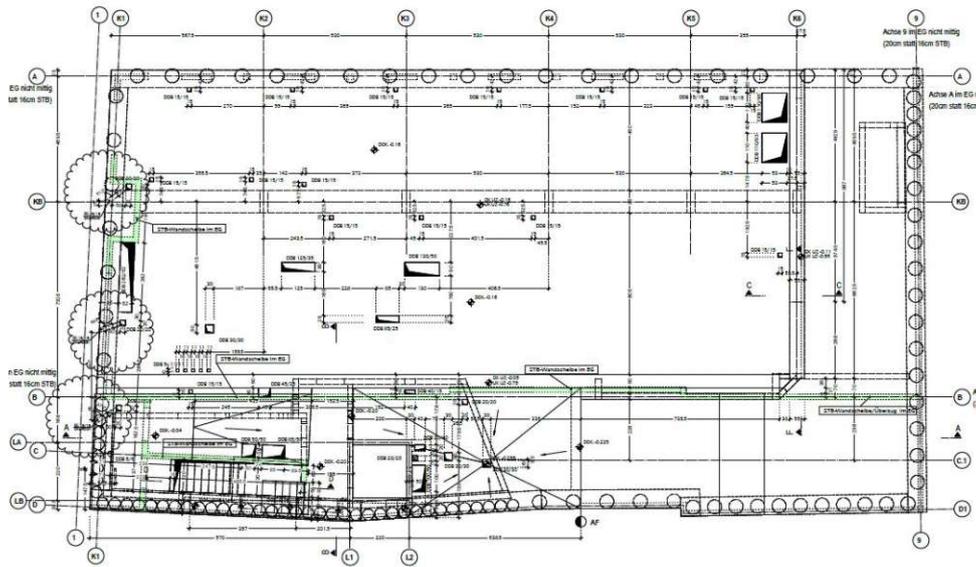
Grundriss des Erdgeschosses inklusive der zur Errichtung eines Stockwerkes notwendigen Arbeitsschritte [45]
